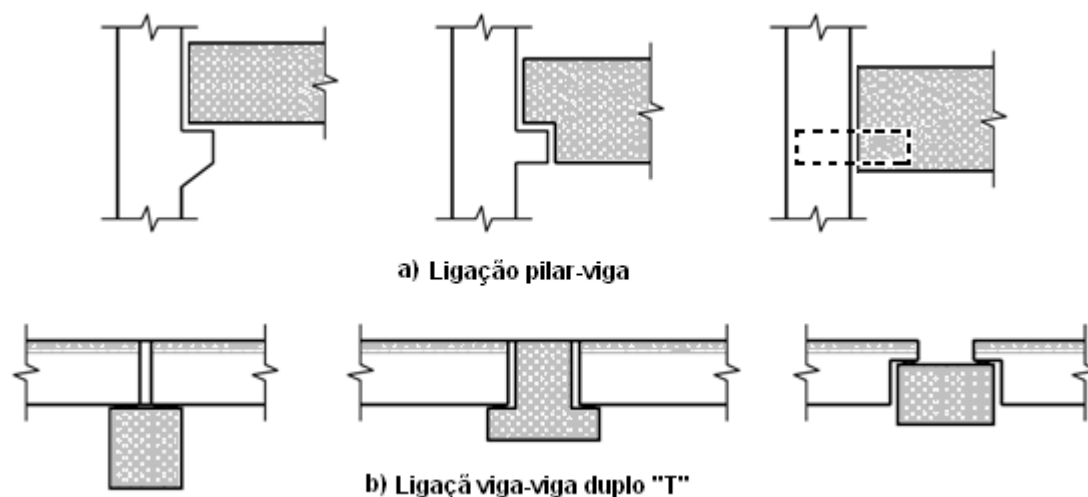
Ligações alternativas com diferentes aparências estéticas: a) ligações viga-pilar, b) ligações laje duplo "T" (FIB, 2008)
